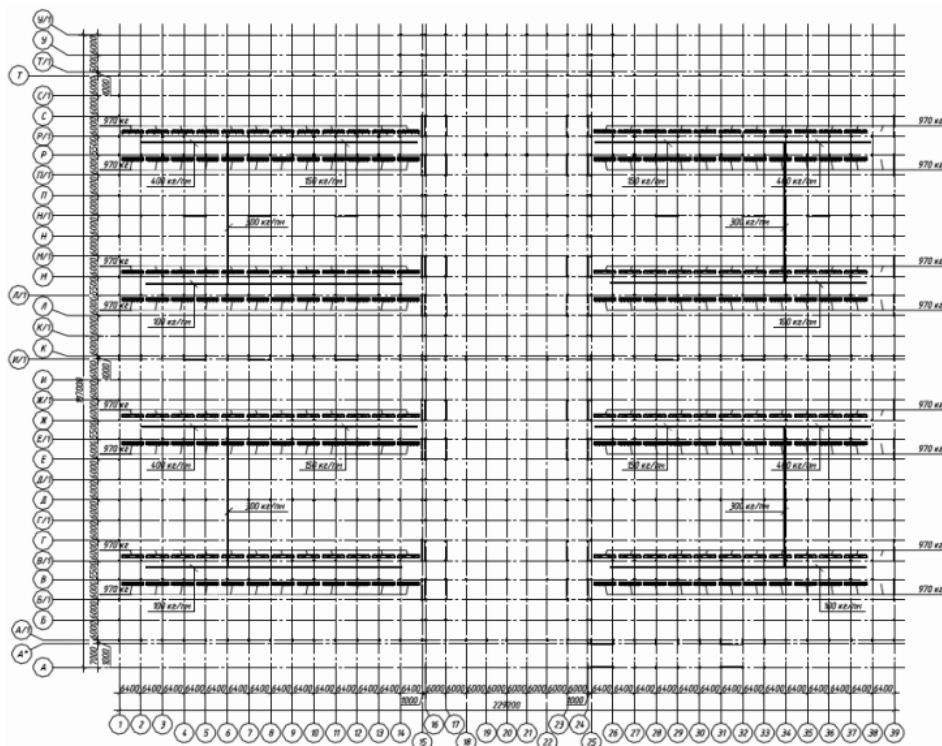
Схема приложения нагрузок от оборудования на отм. +9,000
